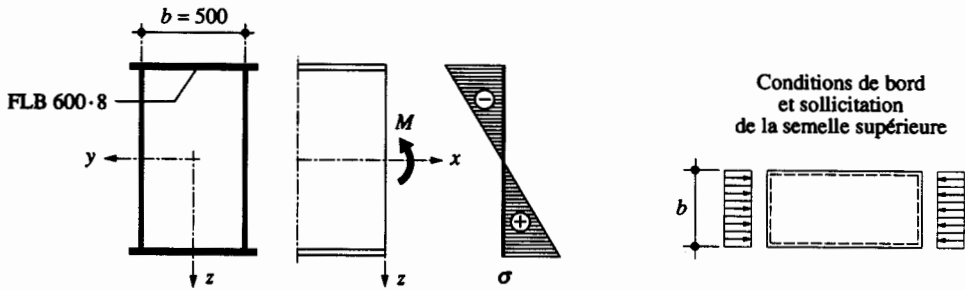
Poutre en caisson soumise à un moment de flexion.
